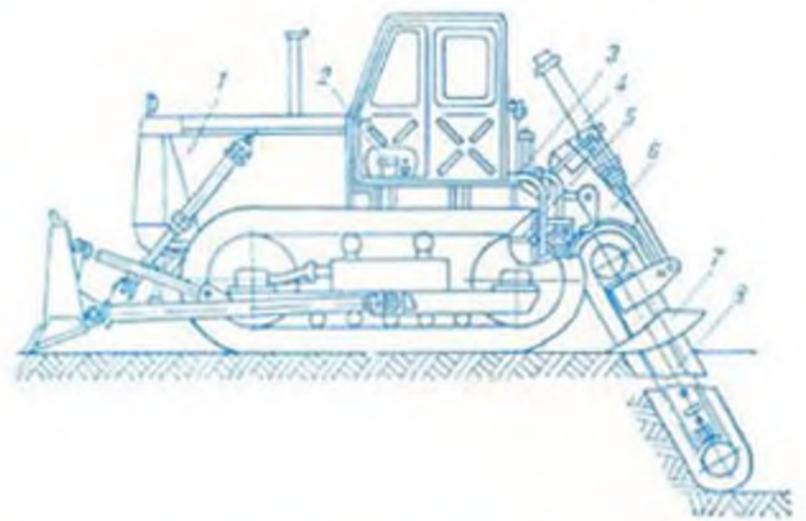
Гусенично-баровая щелерезная машина: 1 — трактор; 2 — гидромеханический ходораздатчик; 3 — гидросистема; 4 — механизм управления рабочим органом; 5 — соединительный вал; 6 — редуктор привода бара; 7 — зачистное устройство; 8 — рабочий орган (бар).
